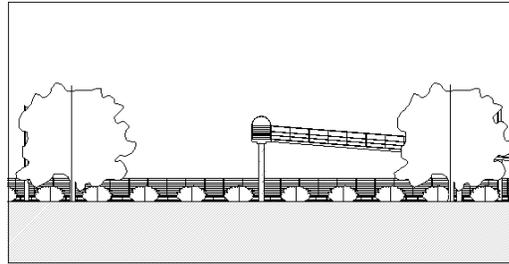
Alzado definido utilizando el rango de vista de la imagen a la derecha de la ilustración anterior
